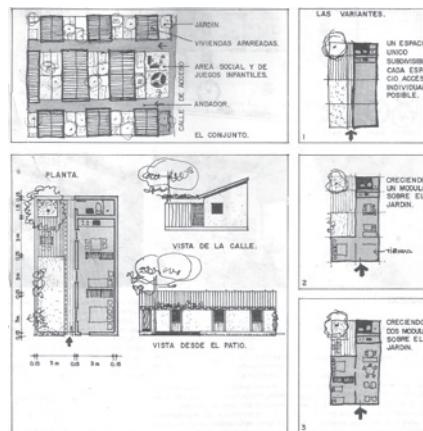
Proyecto diseñado por Fermín Estrella, Carlos Levinton e Irene Joselevich para la reconstrucción de viviendas afectadas por el incendio en la Villa 31, replicado luego en otras villas de la ciudad y el conurbano. Fuente: Estrella, Fermín, Arquitectura de Sistemas al Servicio de las Necesidades Populares (1964-1983), Ciudad de México, Hachette, 1984, pág. 185.
